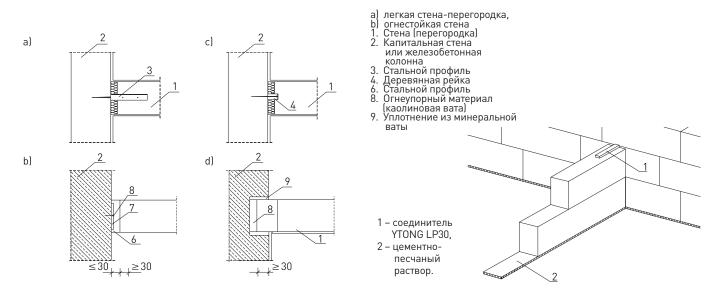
Соединение стены-перегородки с капитальной стеной или железобетонной колонной
